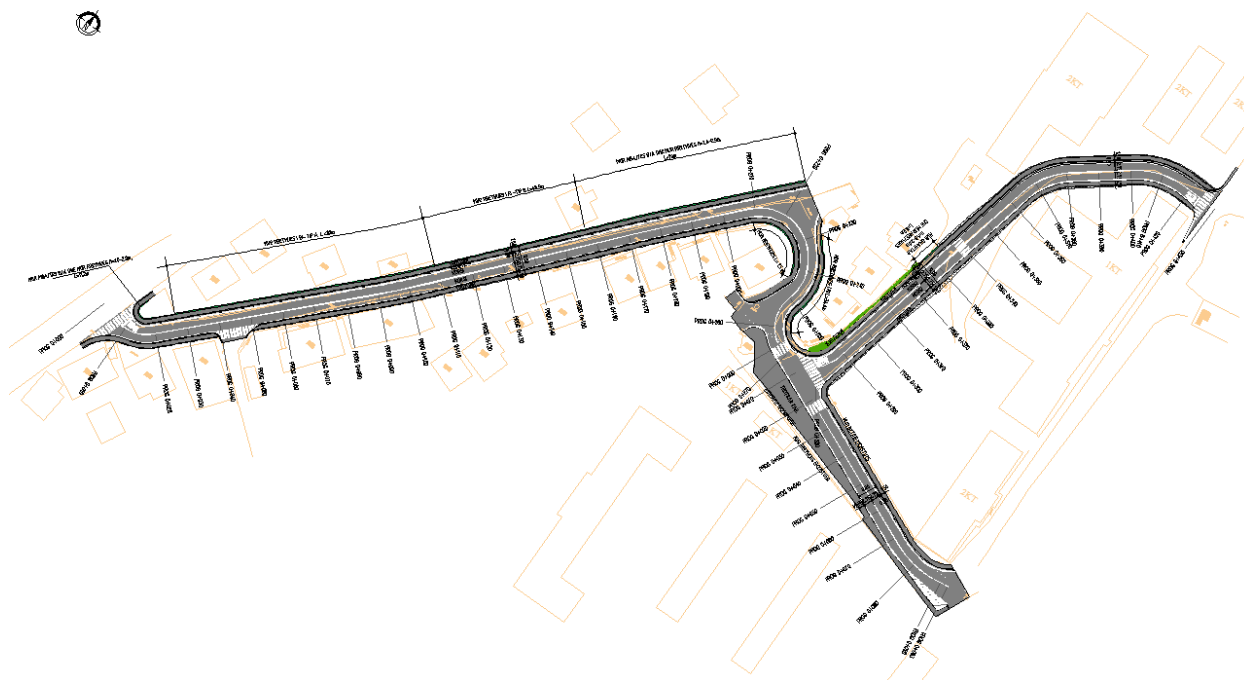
Planimetria e rruges sipas projekt zbatimit
